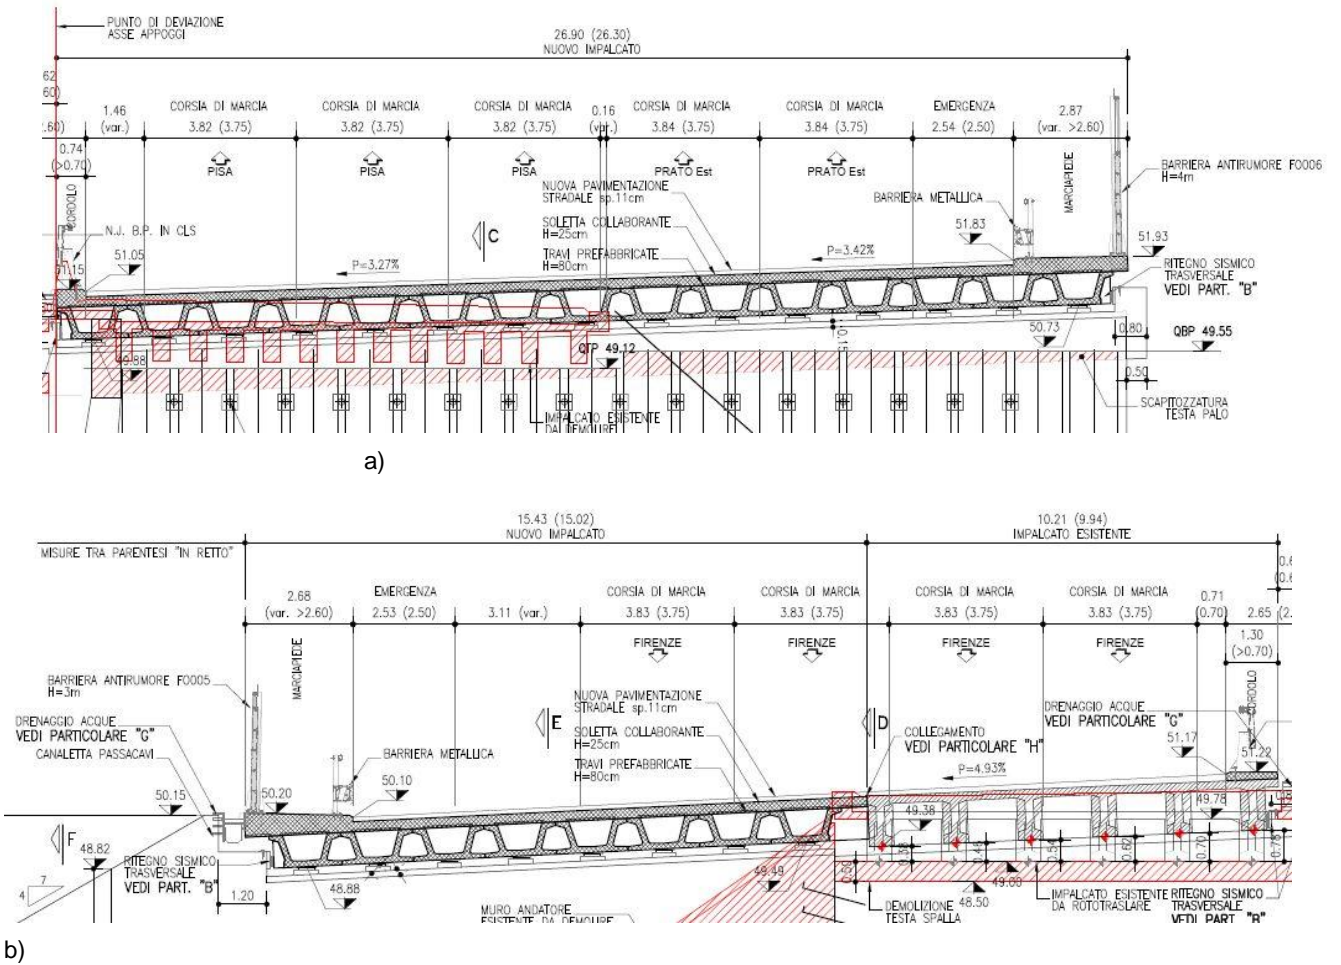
Sezione tipo struttura ampliamento sottovia: direzione Pistoia a); direzione Firenze b).
